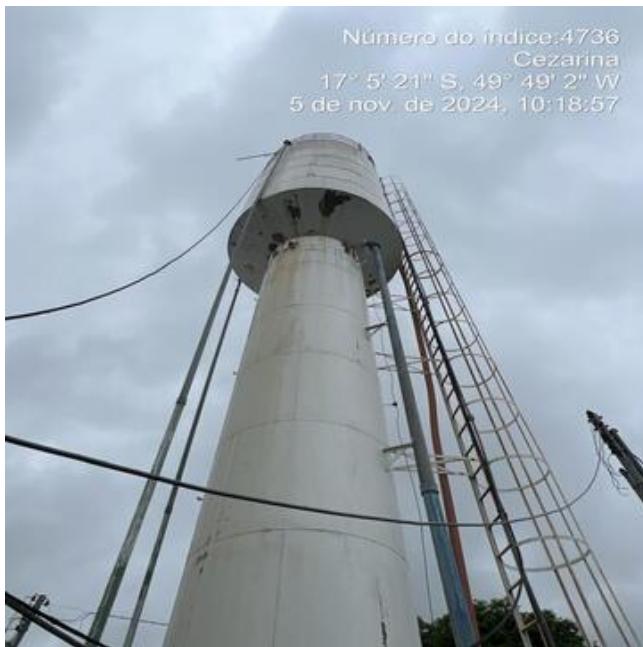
C.R. Linda Vista REL/50 m³ metálico com pintura desgastada.
